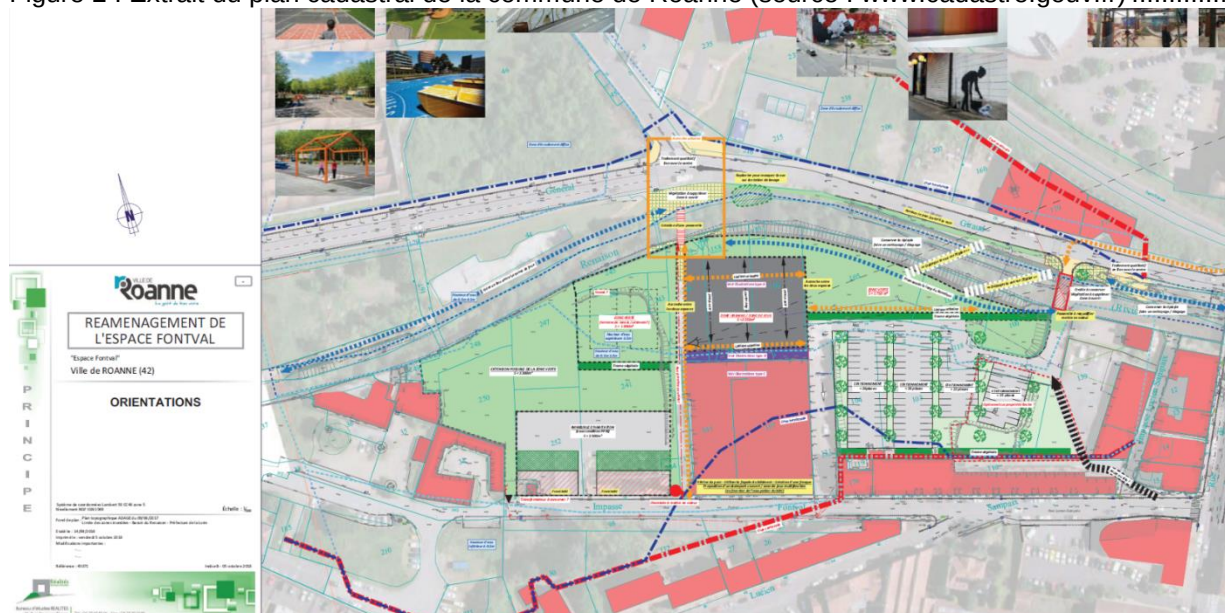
Plan d'orientation du projet d'aménagement (Source : Mairie de Roanne) .....8
